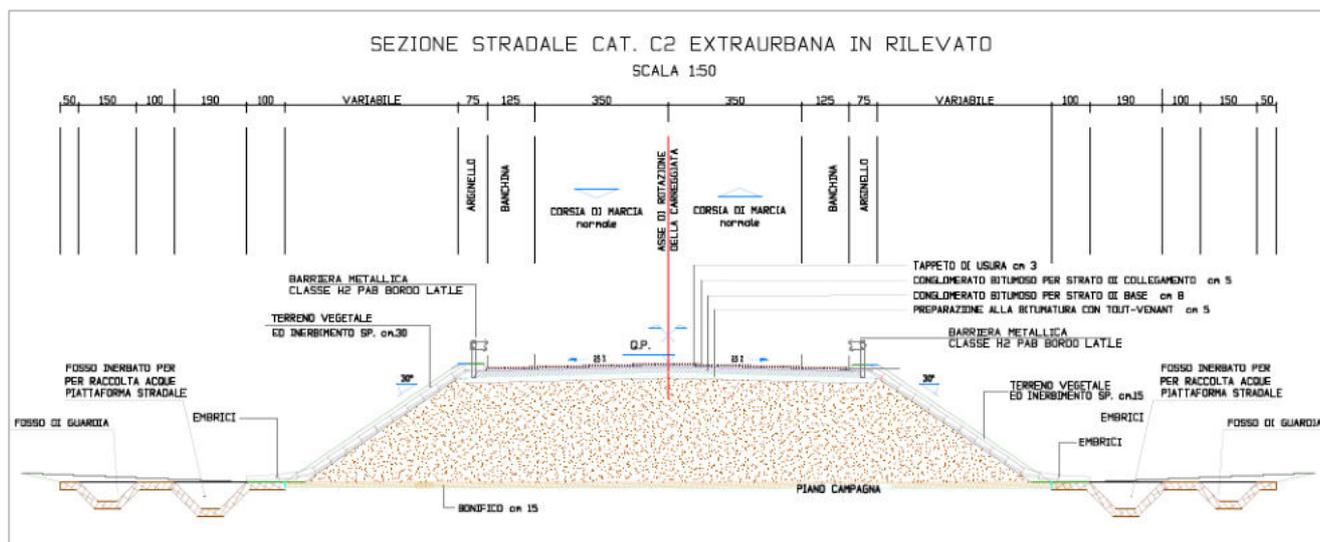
/1 Sezione tipo tratti in rilevato
